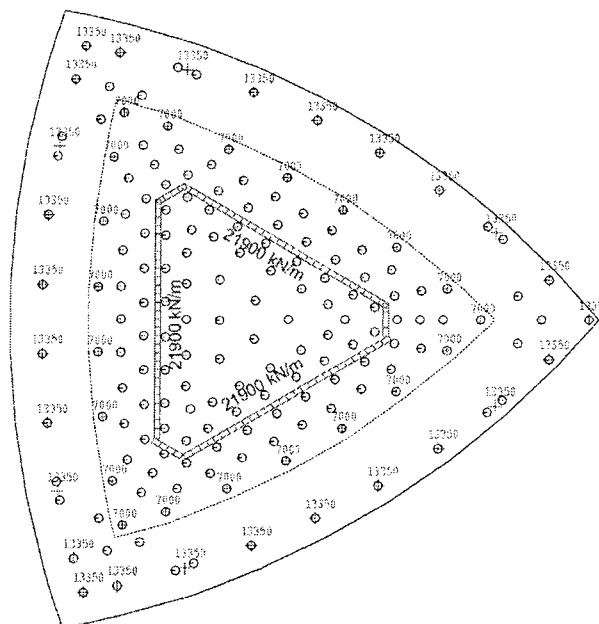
Grundriss des Hochhauses mit Pfählen
